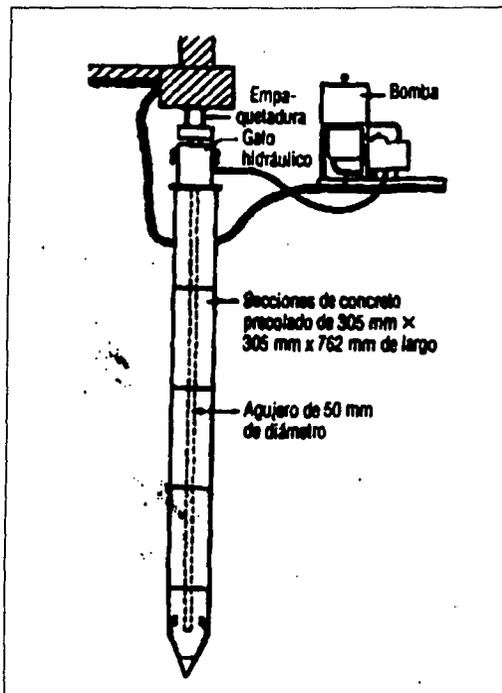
Recimentación con el Pilote Franki Miga⁽⁶⁾
